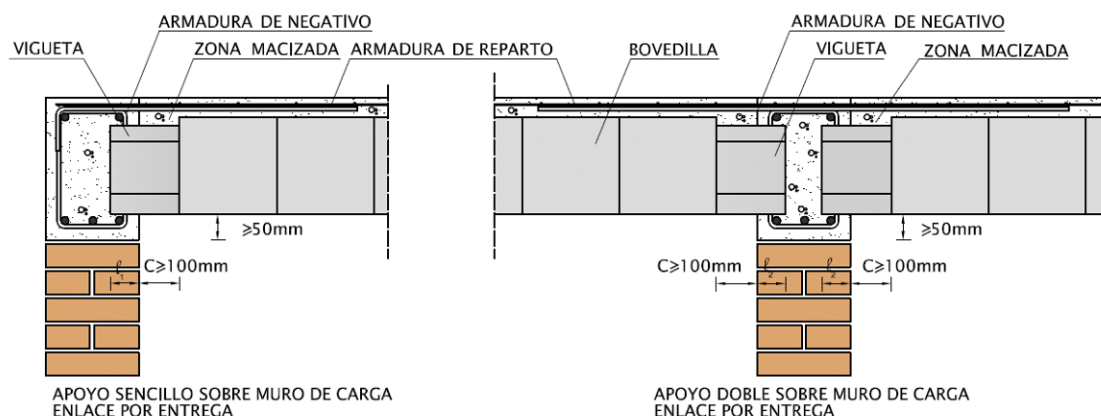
Apoyo sobre muro de carga. Enlace por entrega
